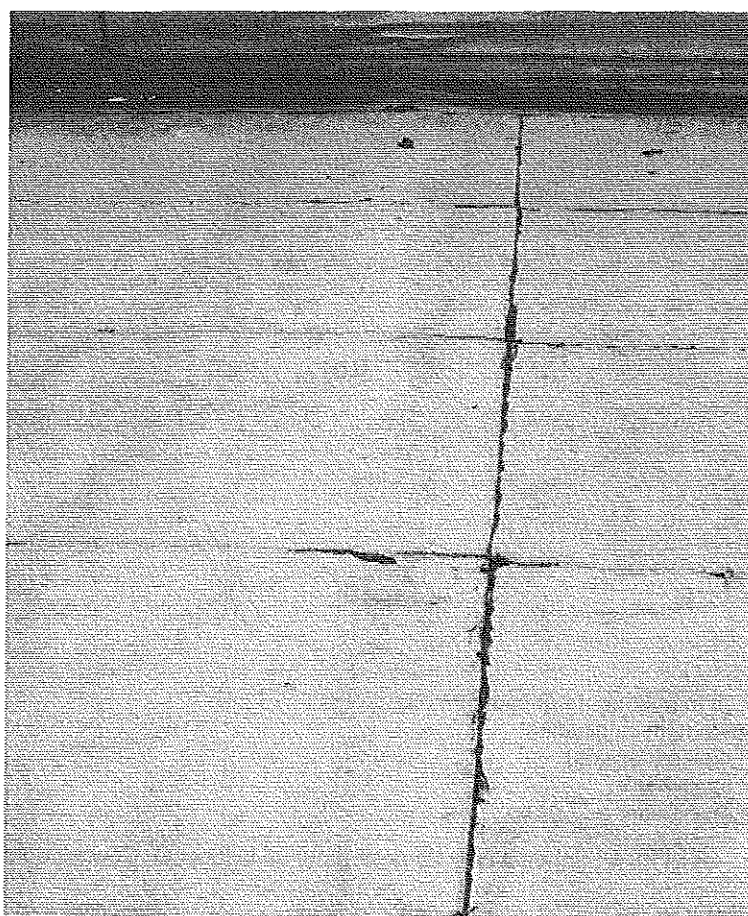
Pose d'un revêtement d'étanchéité autoprotégé sans découpe des joints. © J. Putatti
